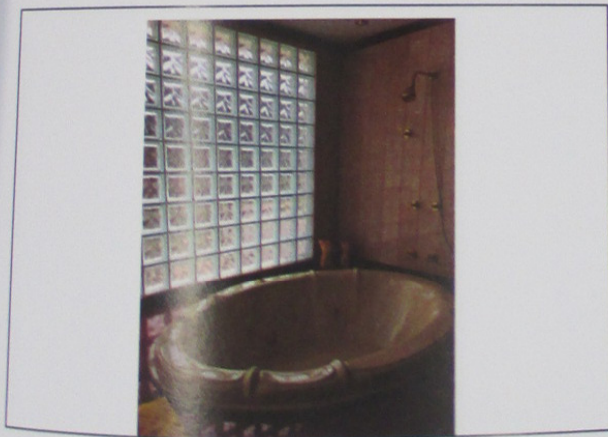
Vista do Banheiro da Suíte 4.
